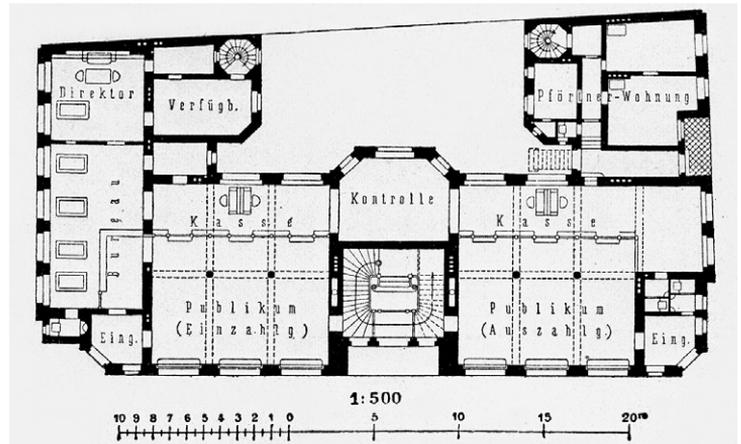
Erdgeschoss des Gebäudes des Danziger Sparkassen-Vereins (Mitte der 1880er Jahre erbaut)
